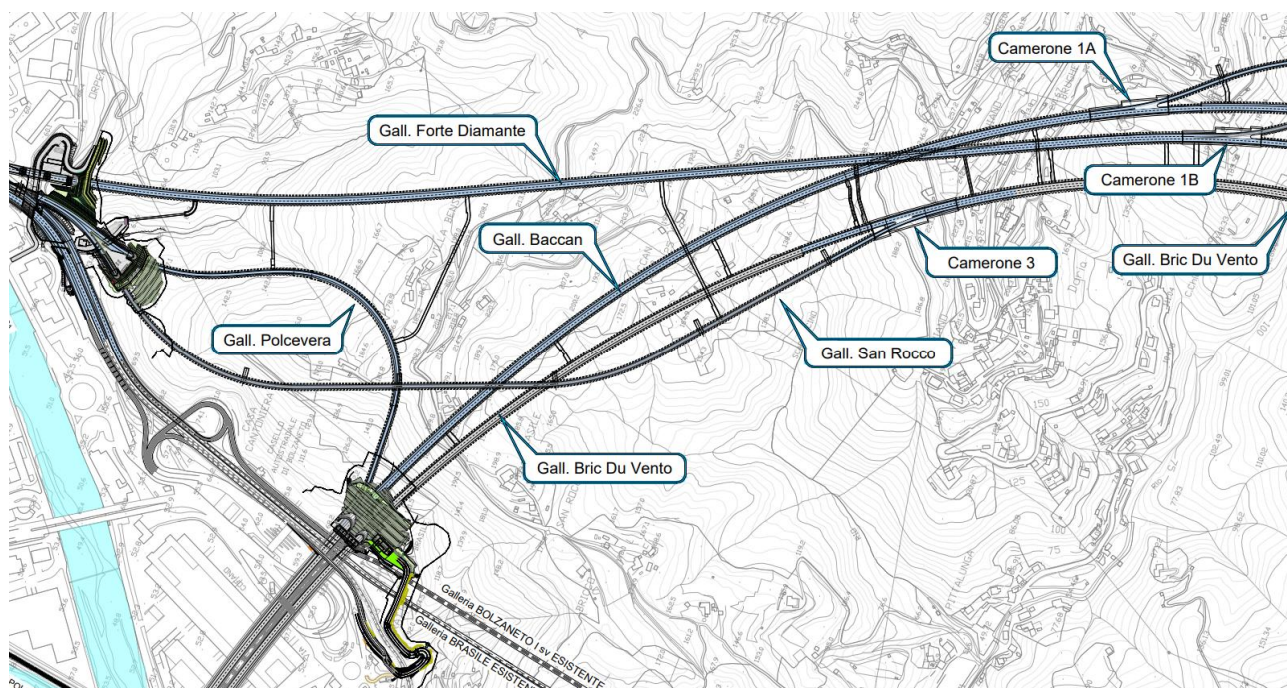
Corografia lato Bolzaneto delle gallerie oggetto di variante (in blu i tratti variati rispetto al progetto approvato)
